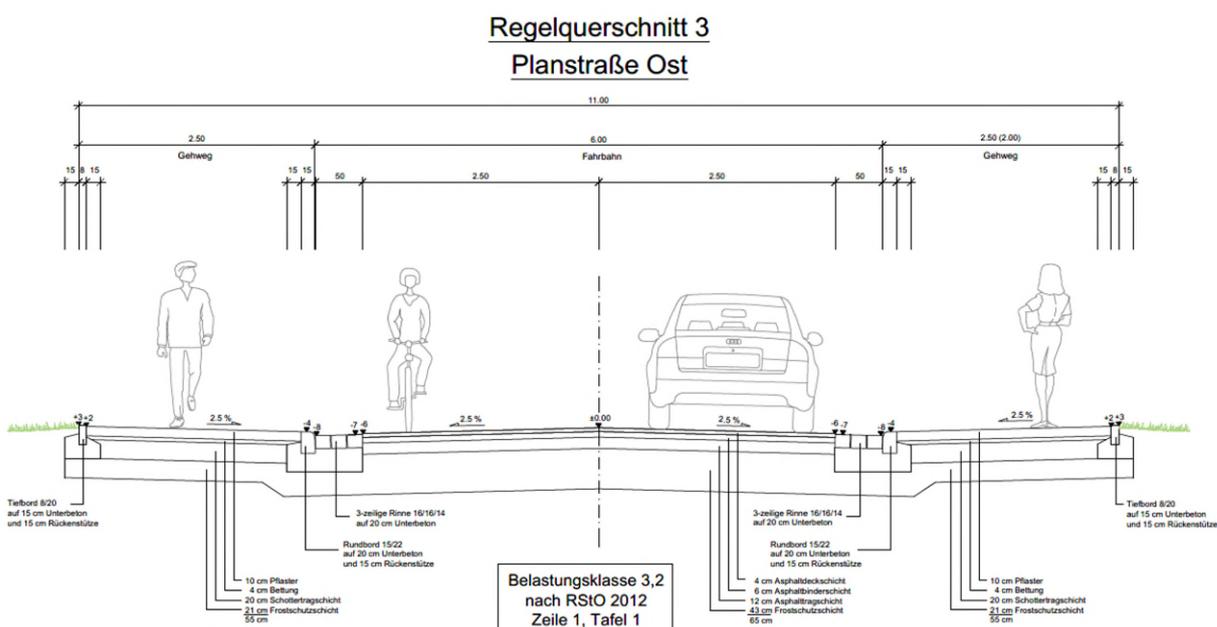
Regelquerschnitt Planstraße Ost, Darstellung IB Becker
